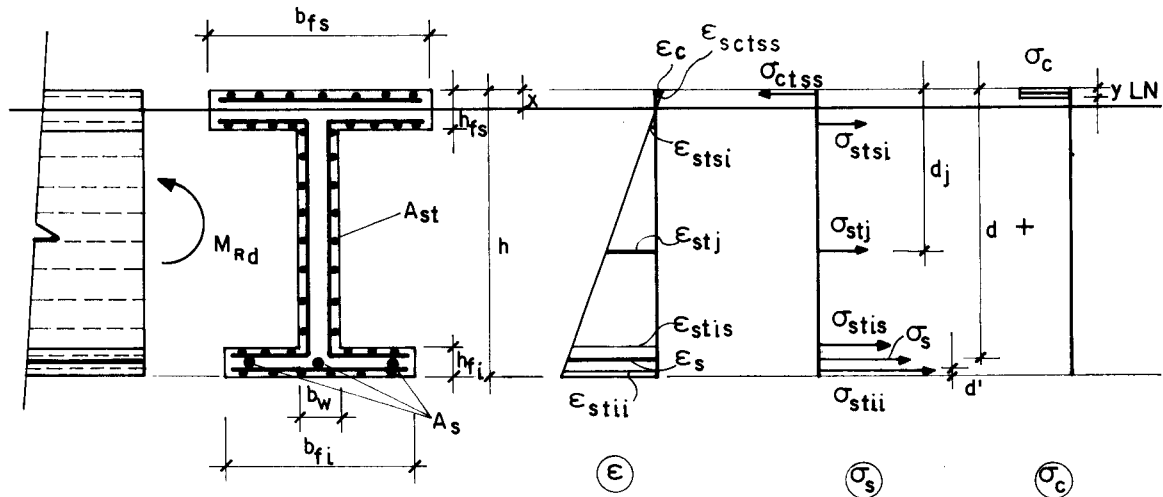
FLEXÃO SIMPLES - LN. NA MESA DE COMPRESSÃO
